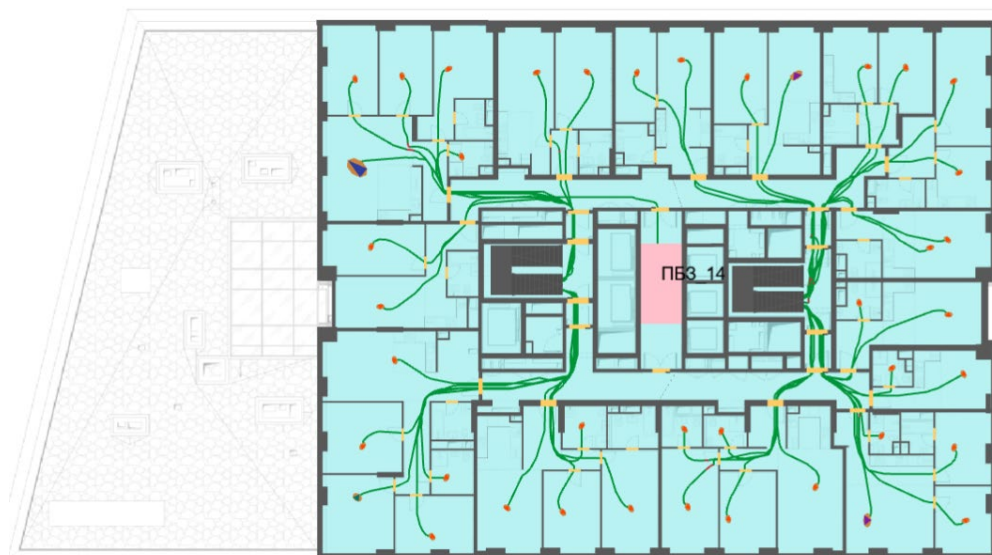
План 14-го этажа и нанесенная на него расчетная (принципиальная) схема эвакуации
